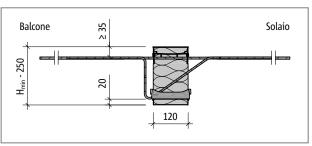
Schöck Isokorb® tipo KXT15 – KXT40: sezione dell'elemento
